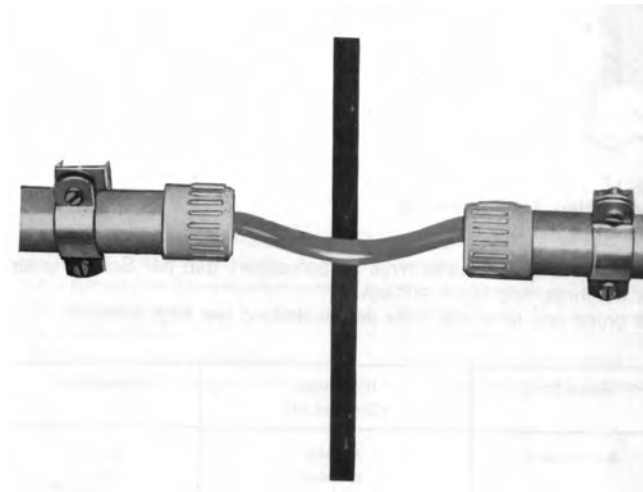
Interruption du tube de protection au niveau d'un joint de dilatation
